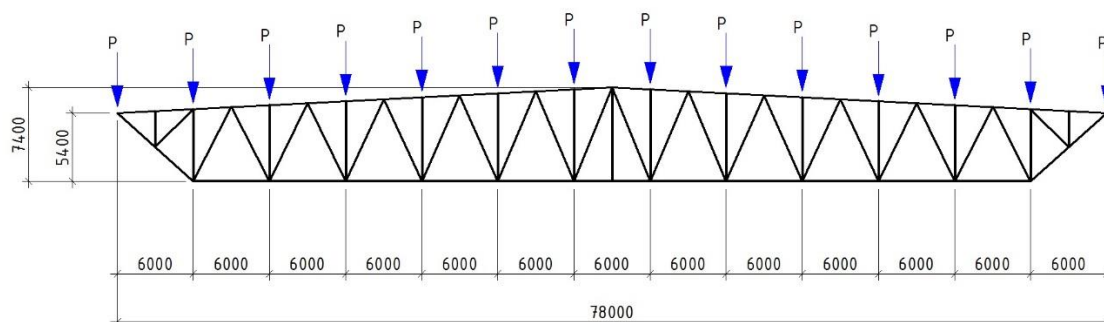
Геометрическая схема фермы с приложенной узловой нагрузкой
